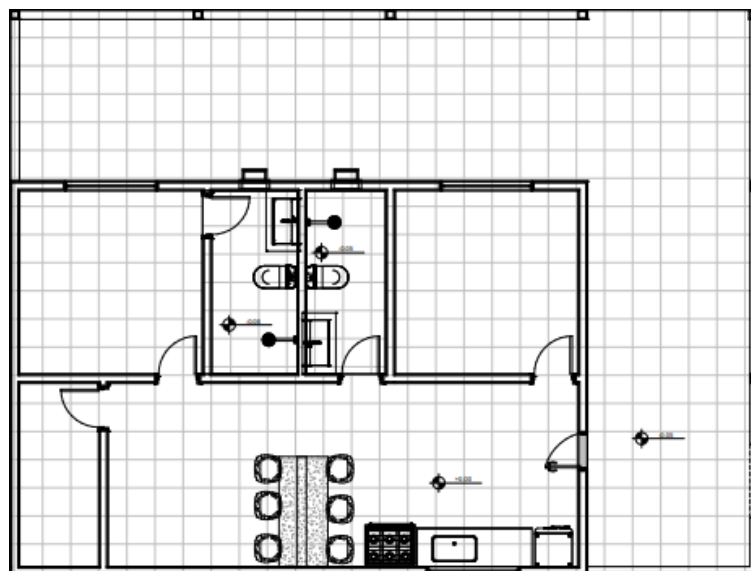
Planta baixa Layout: Casa. (Fonte: Autoria própria; 2022)
